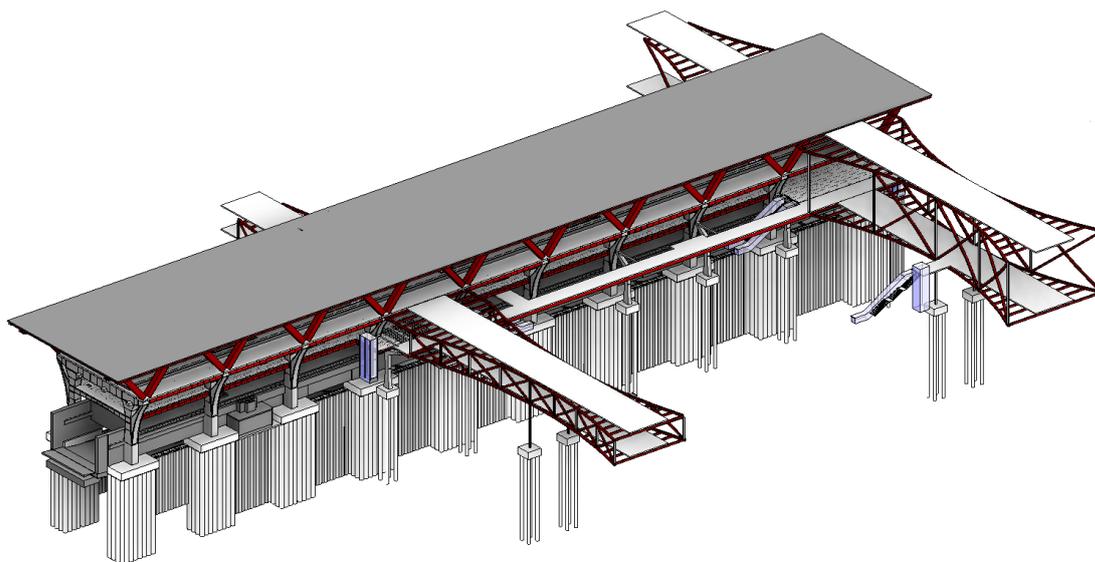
Sistemas estructurales diseñados: estación elevada del TITM, paso inferior de la Av. Minas de Arena y pasarelas transversales. Fuente: SENER Ingeniería.
